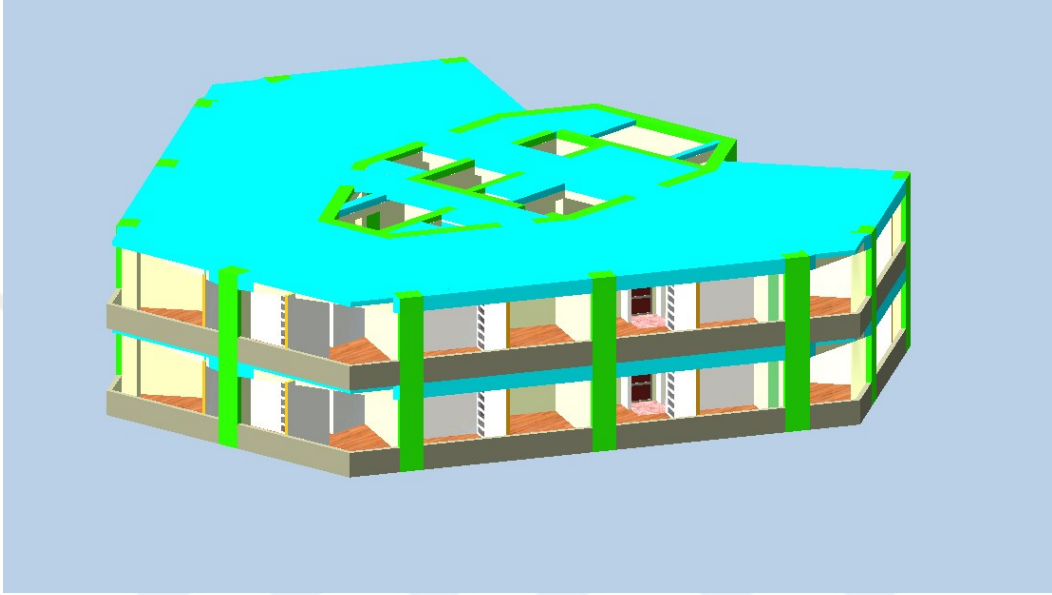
Revit Bölge Bazlı Malzeme Rapor Örneği
